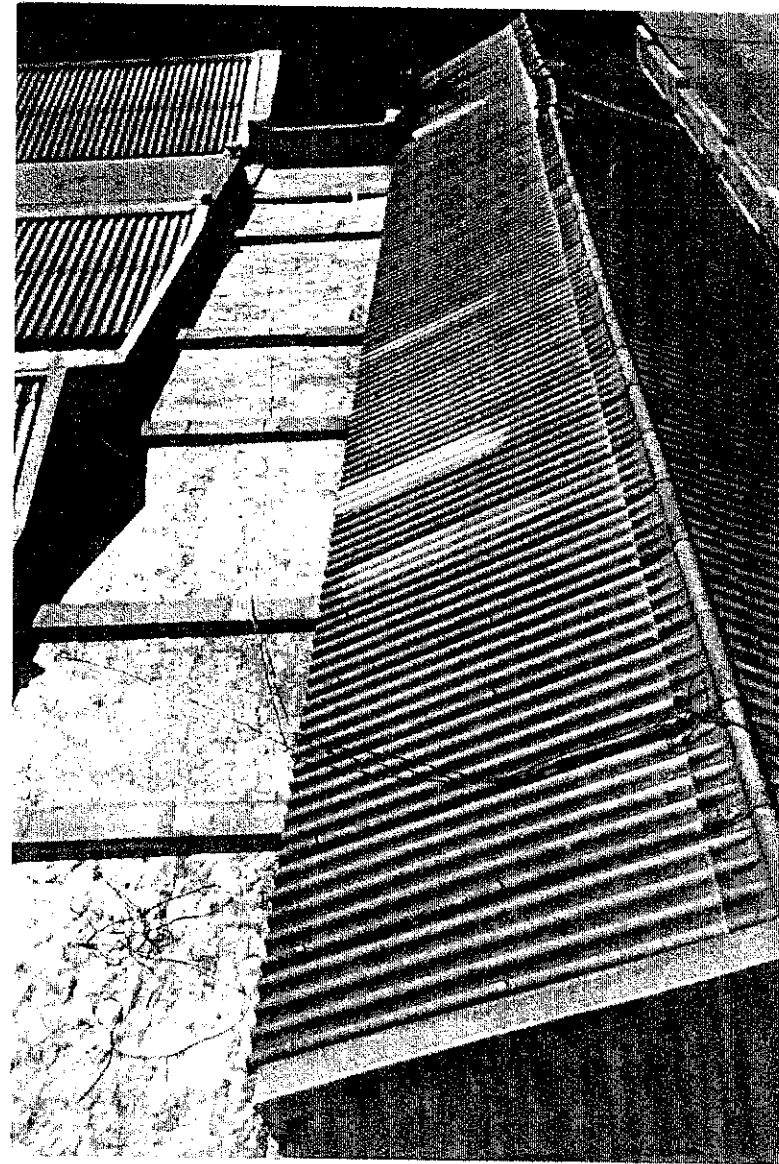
Cubierta dañada y rompe con el estilo arquitectónico del edificio.
